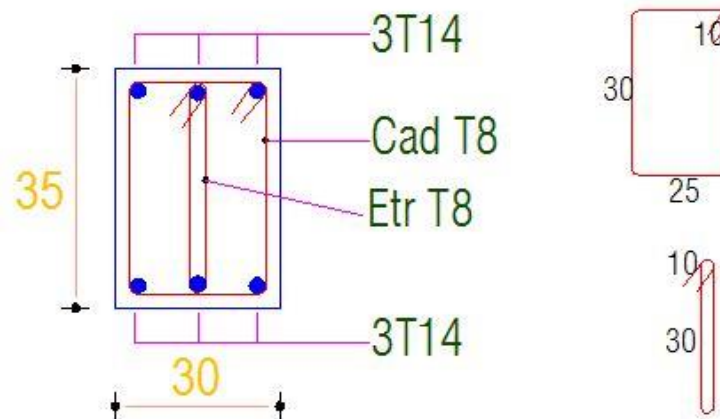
Schéma de ferrailage de la poutre secondaire.
